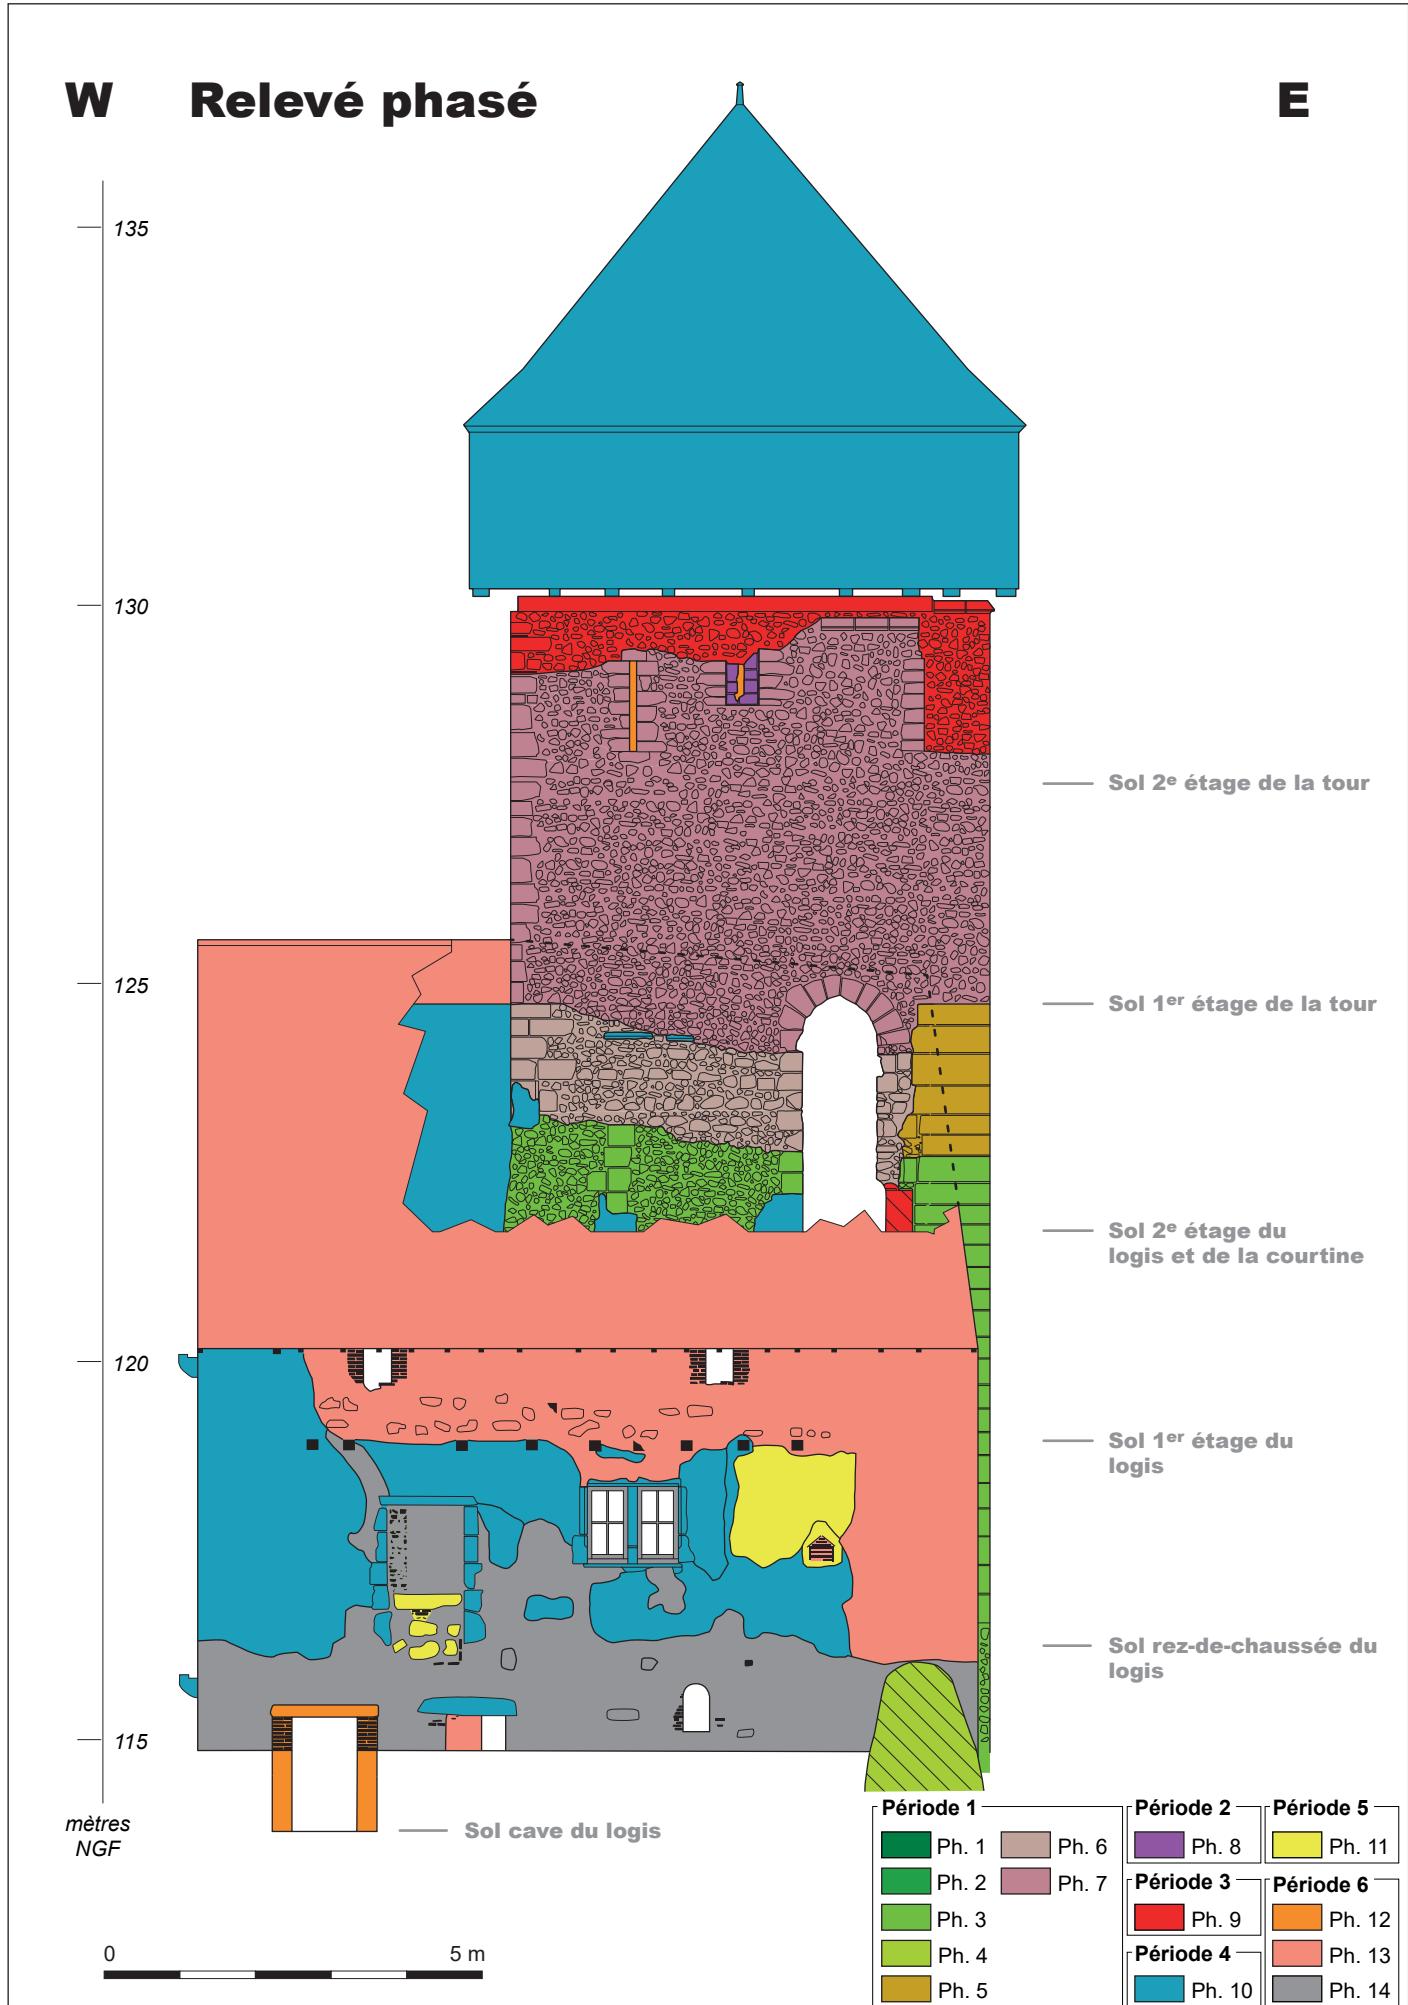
Elévation phasée du mur sud de la tour et du bâtiment adossé
